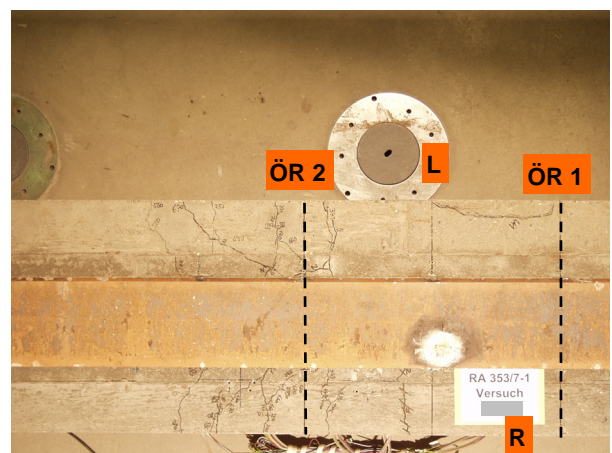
Rissbild auf der Betongurtunterseite
